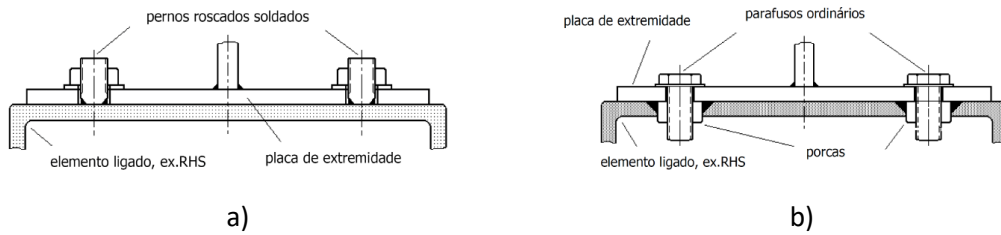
Exemplos de ligações aparafusadas: a) Soldadura de pernos roscados,[18]; b) Fêmeas soldadas, [18].
